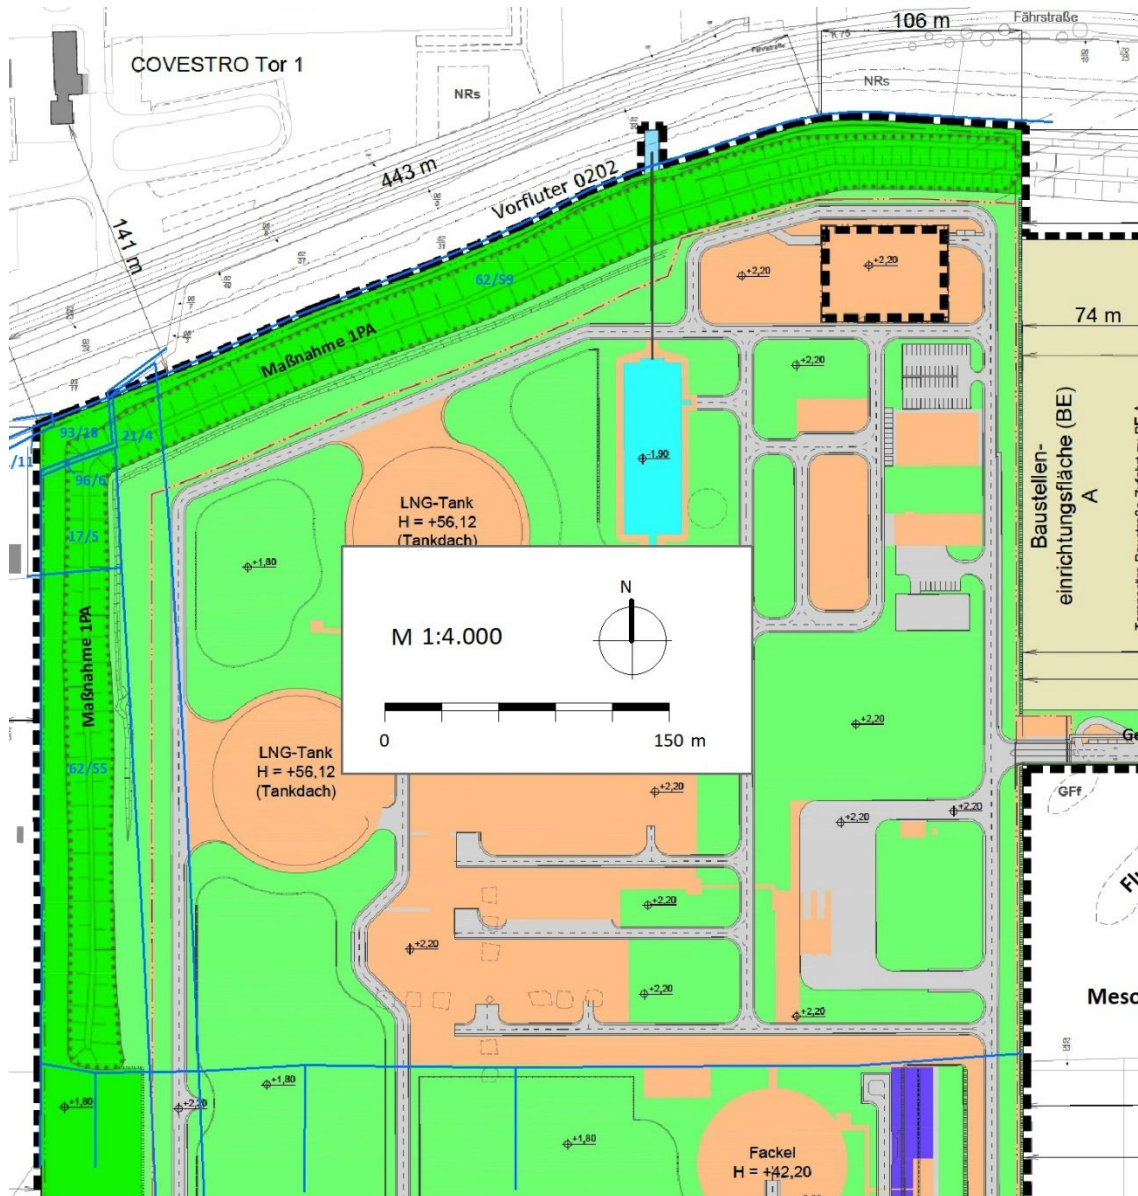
Maßnahme 1PA, Pflanzung einer Strauchhecke auf dem bestehenden Wall, Flurstücke und Flurstücksnummern blau (alle Gmk. 3016, Flur 110), (vgl. Vorhabenplan, Unterlage 1.4)
